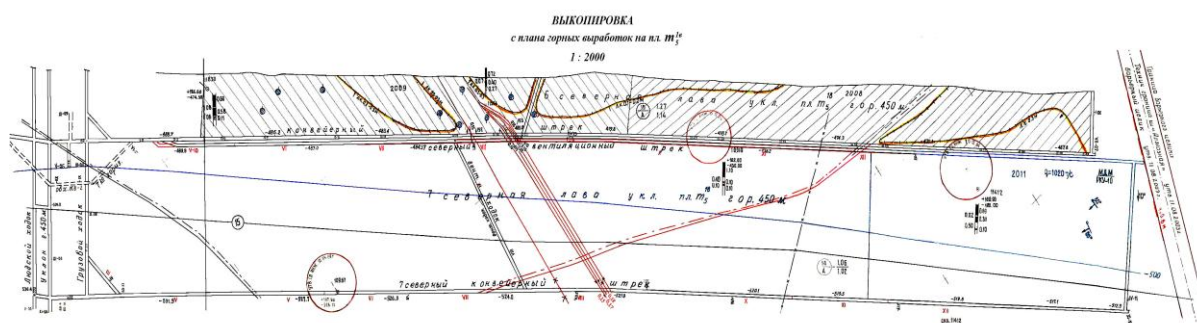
Выкопировка из плана горных выработок по пласту m_5^{1B}
